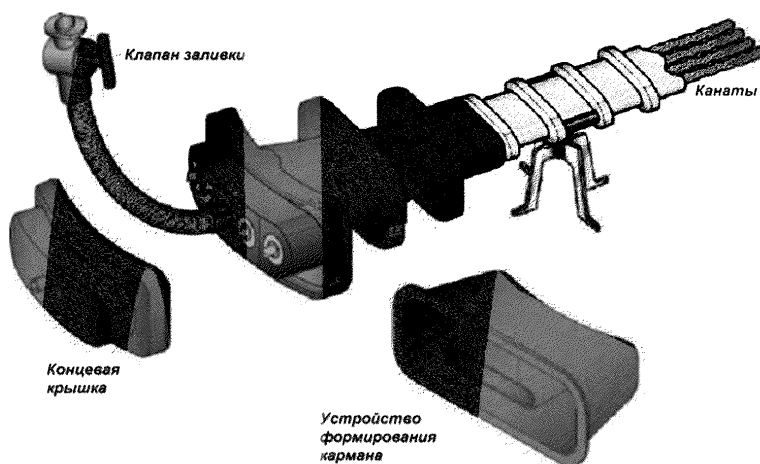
Принципиальная конструкция арматурных напрягаемых элементов и анкеров для систем со сцеплением арматуры с бетоном
